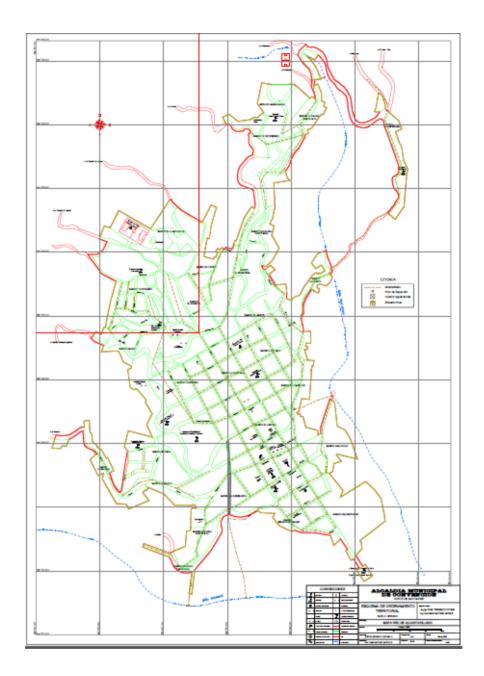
Planos del sistema de alcantarillado. EOT, 2004.
